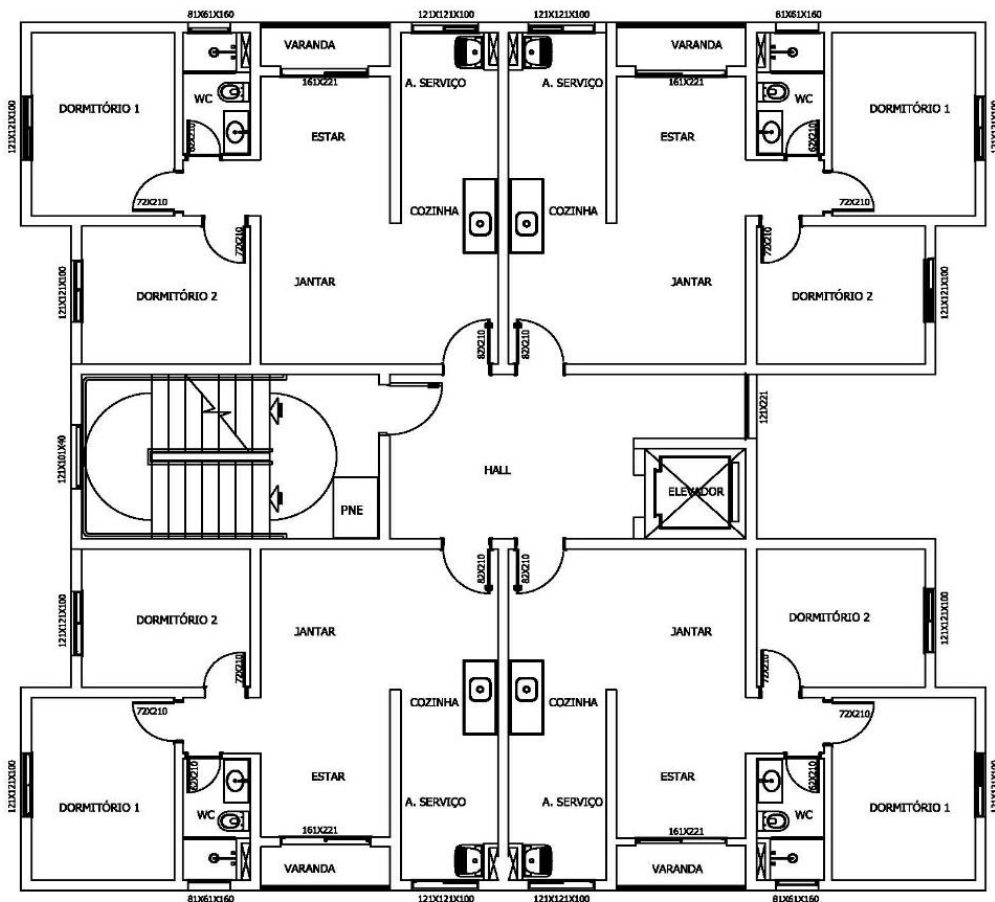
Planta baixa do pavimento térreo (Fonte: autor próprio)
